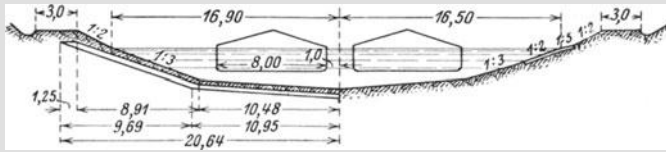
Querschnitt des Berlin-Stettiner Kanals. Maßstab 1 : 575
